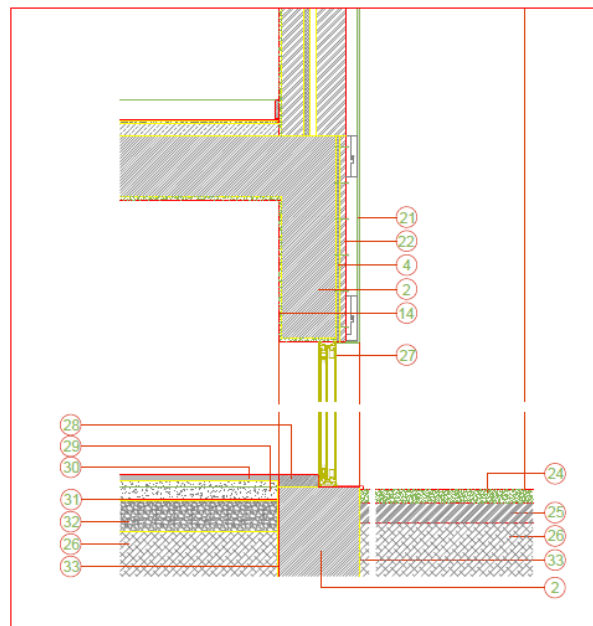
b) Pormenor construtivo do piso 1 corte V2.
